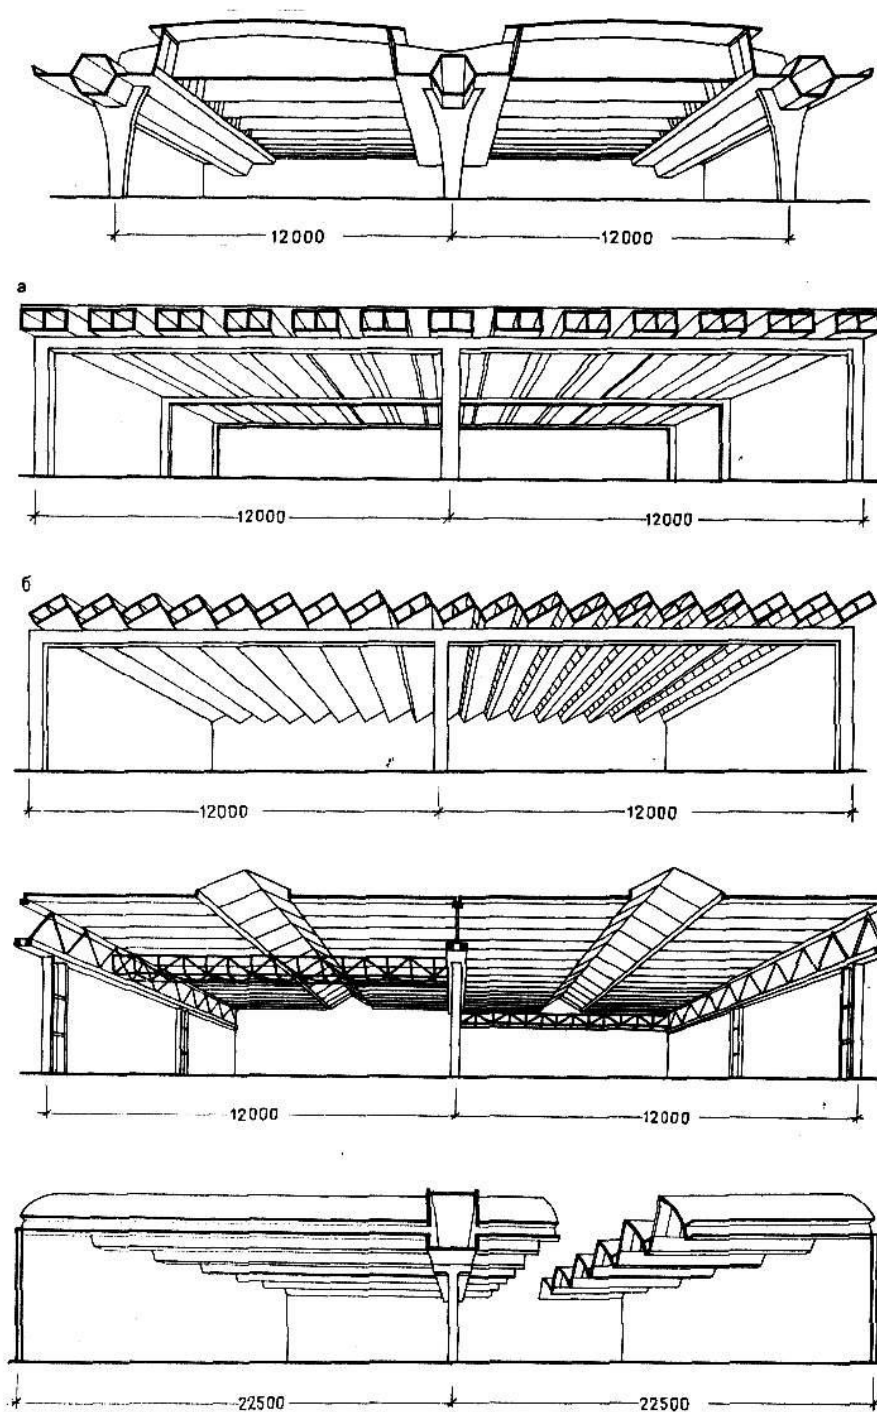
Совмещение функций в несущих железобетонных конструкциях покрытия одноэтажных производственных зданий
